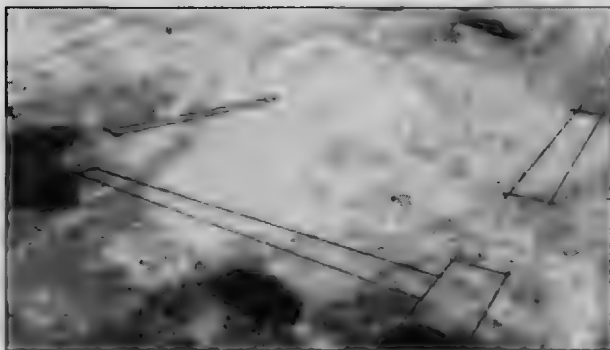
На фундаментной плите следует разметить места расположения внутренних и наружных несущих стен
